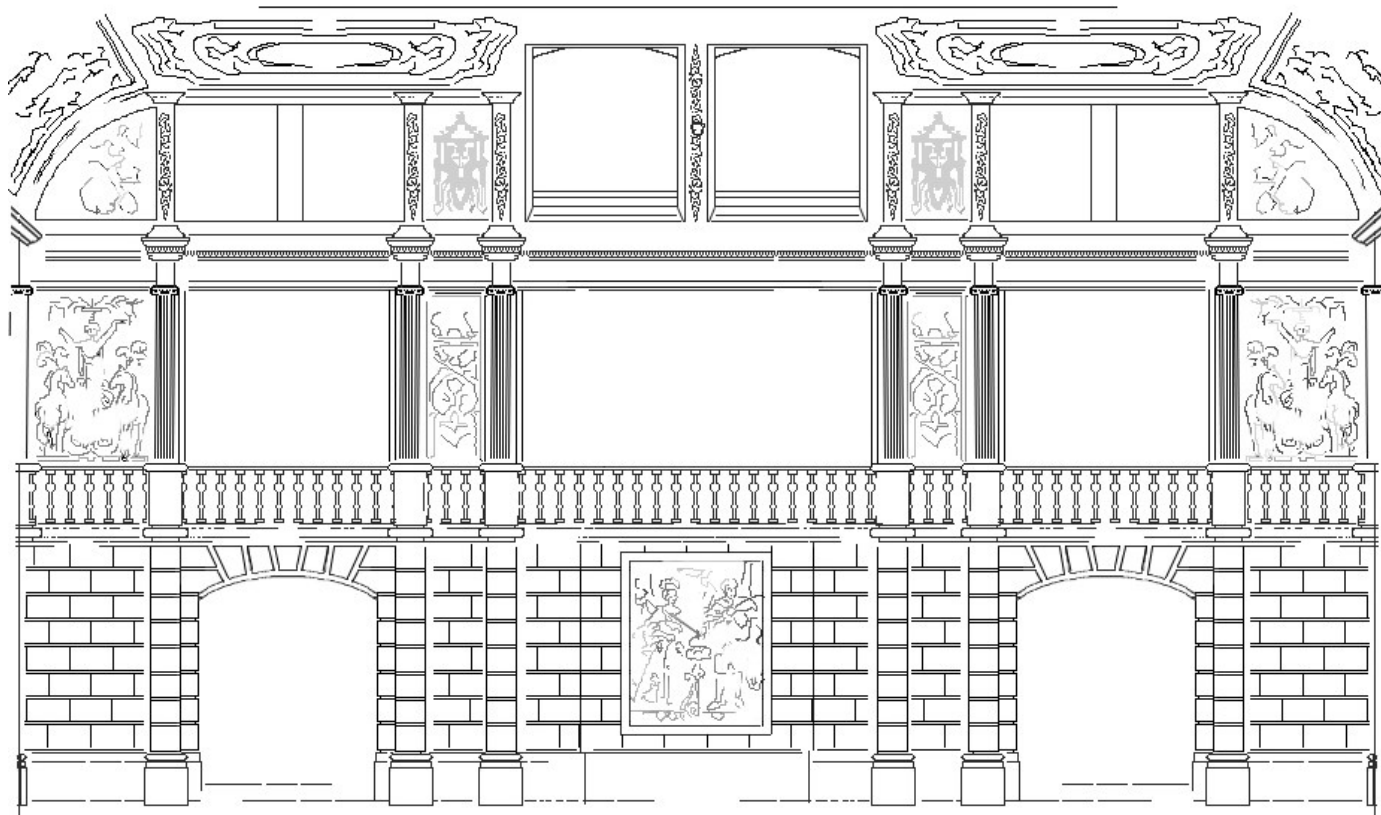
Parede Norte do lado Poente c. 1975. AR-BMNC, accedido a 16.06.21.
